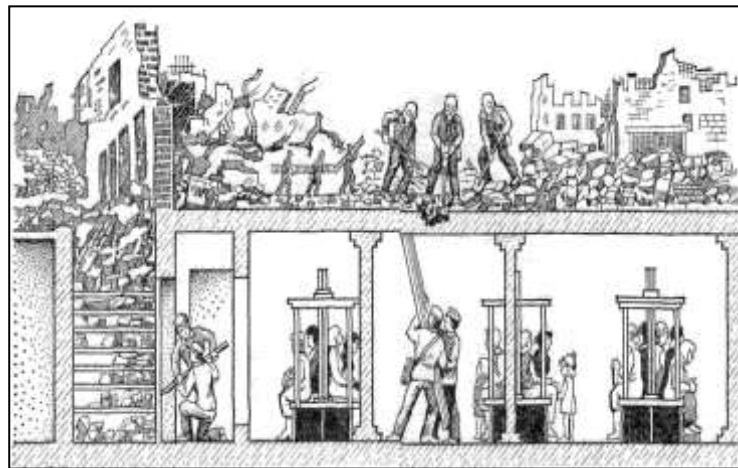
Прodelьвание проемов в стенах и перекрытиях
